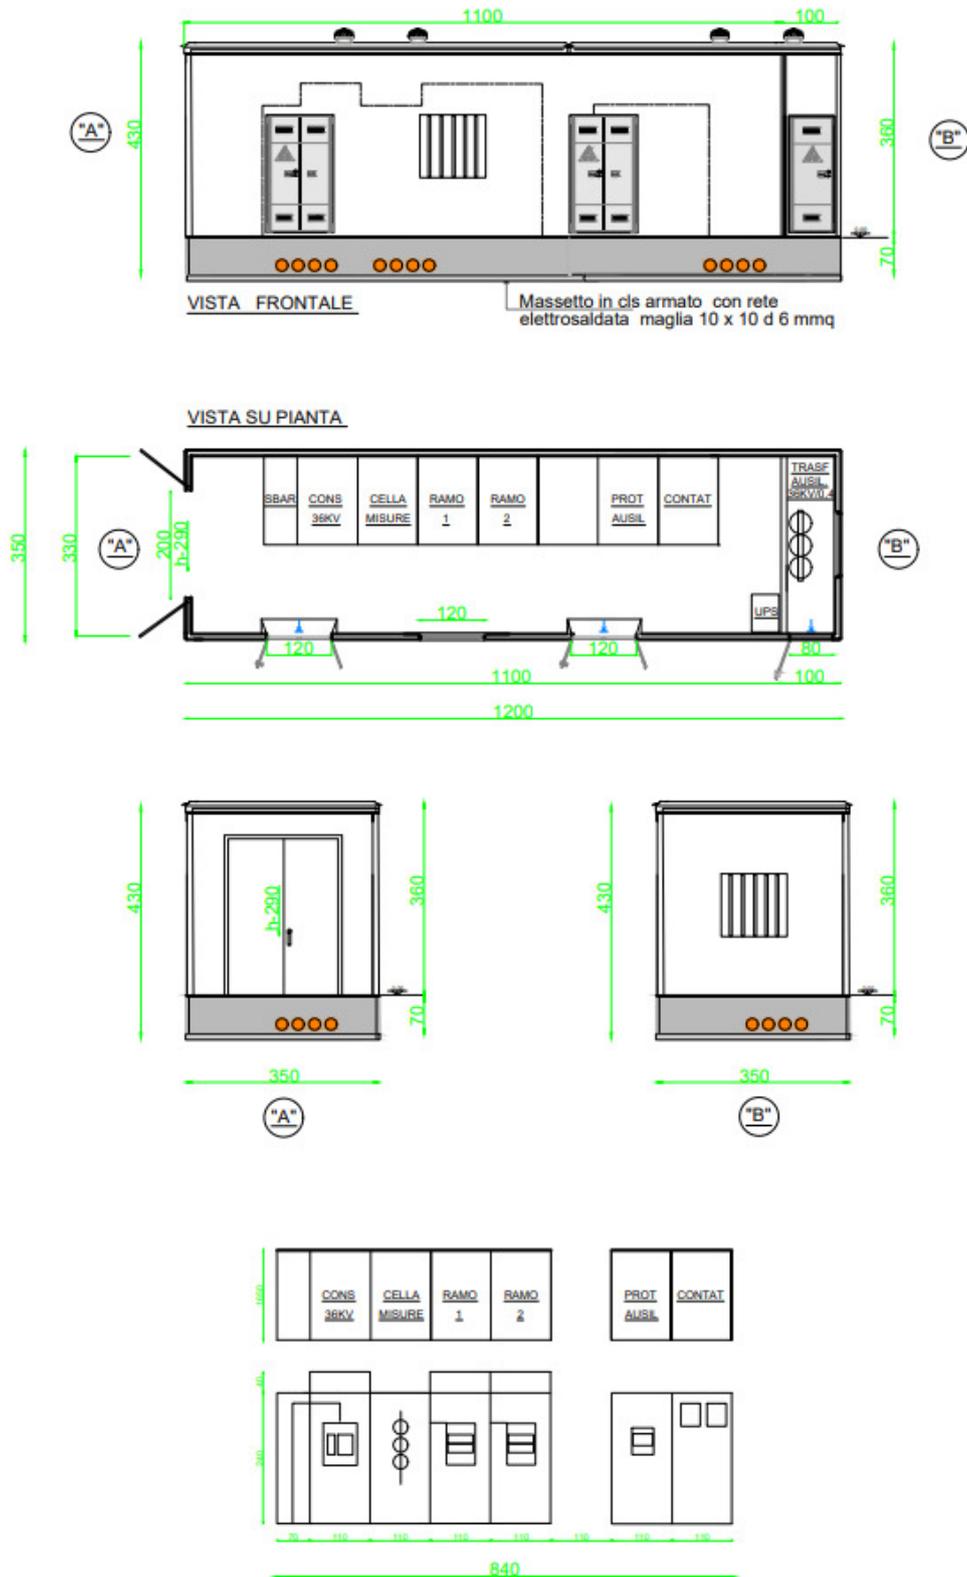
Planimetria e prospetti della cabina di smistamento tipo.
